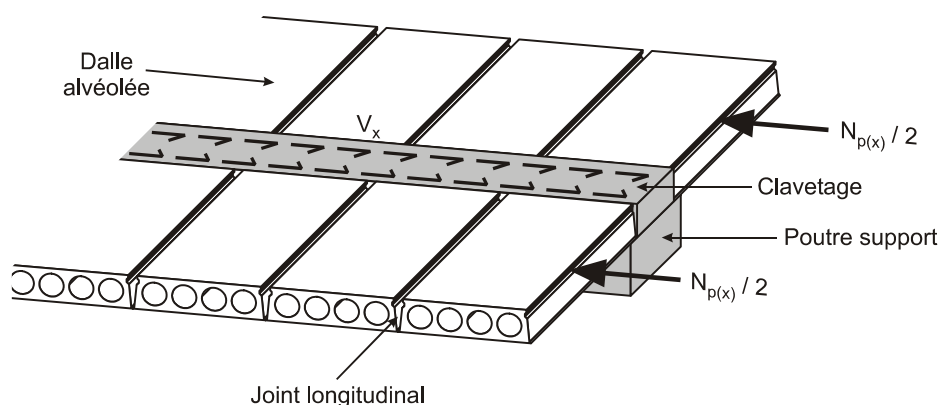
Effort de compression sur la table dû à l'action composite poutre-dalles
